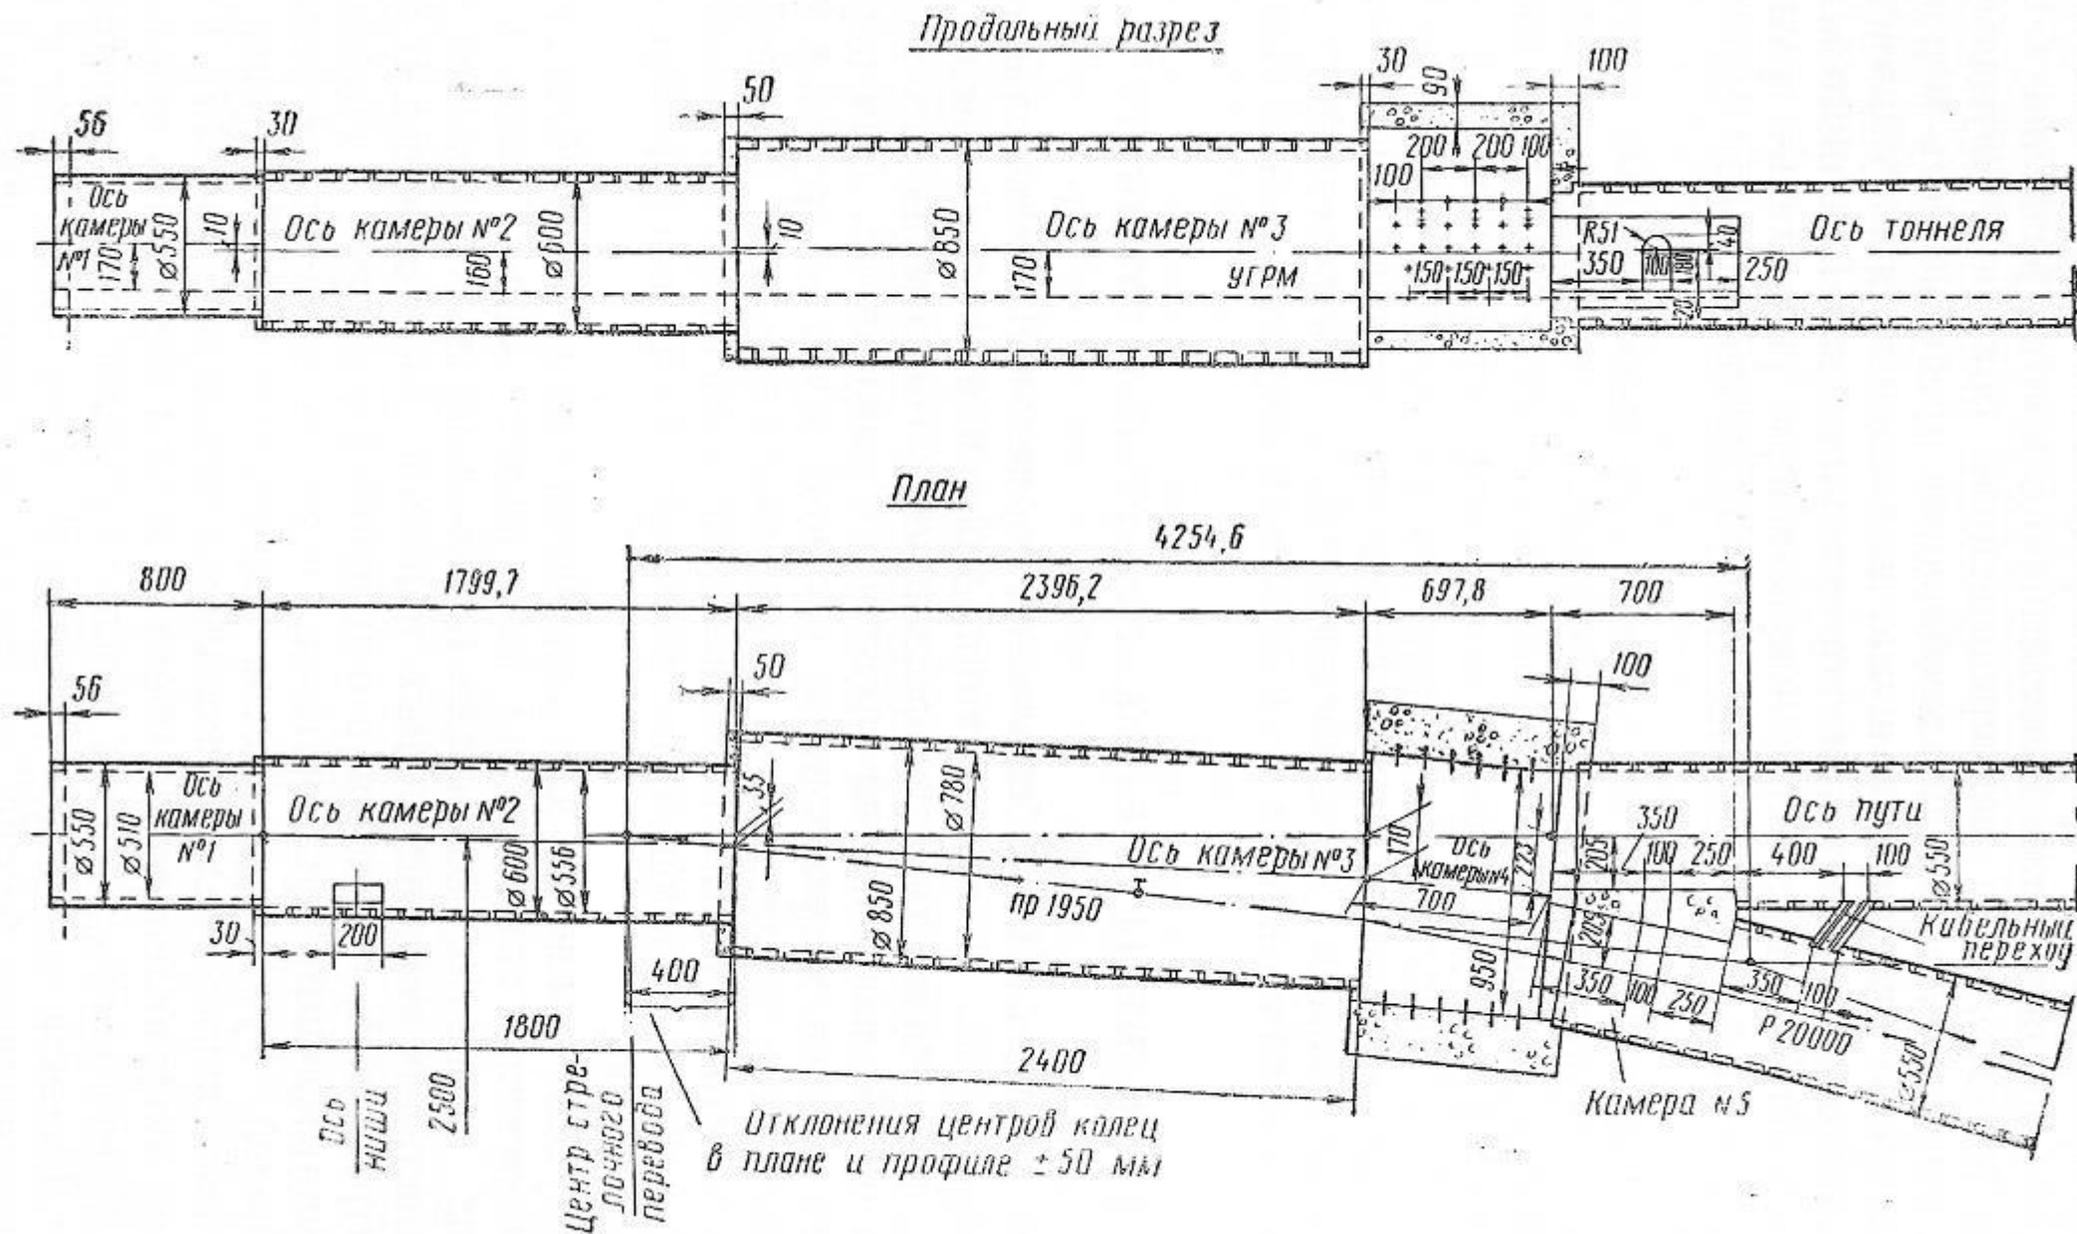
Конструкция камер съезда с обделкой из железобетонных тубингов
